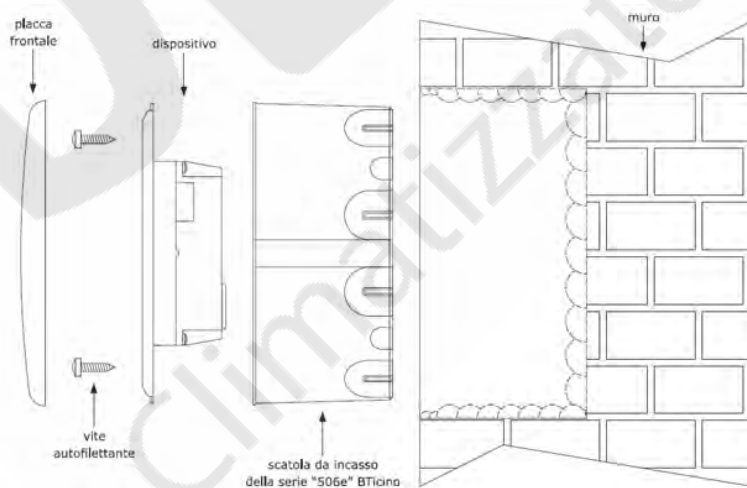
Dimensioni per fissaggio controllo remoto COLOR-TOUCH
